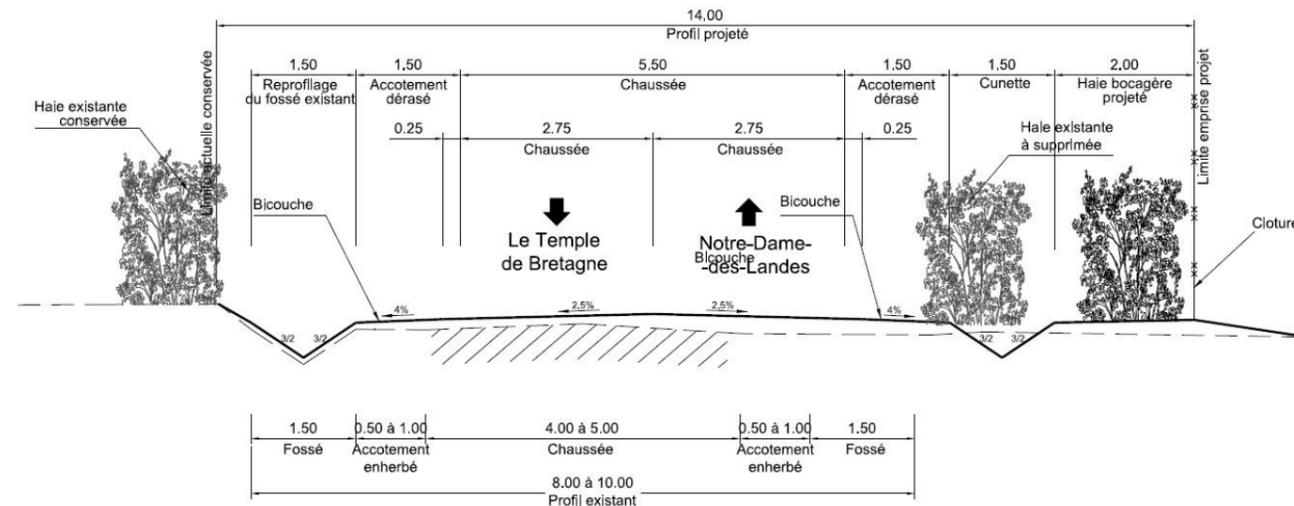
Section courante – Profil en travers de la VC1-VC12 – Elargissement côté droit
